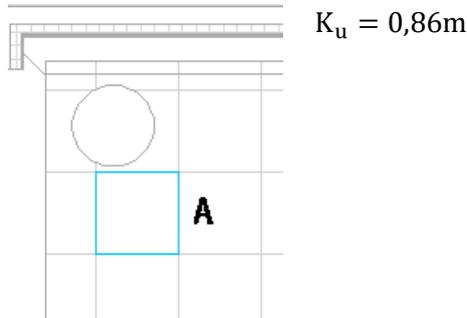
Singolo apparecchio di illuminazione nell'ufficio oggetto di calcolo
